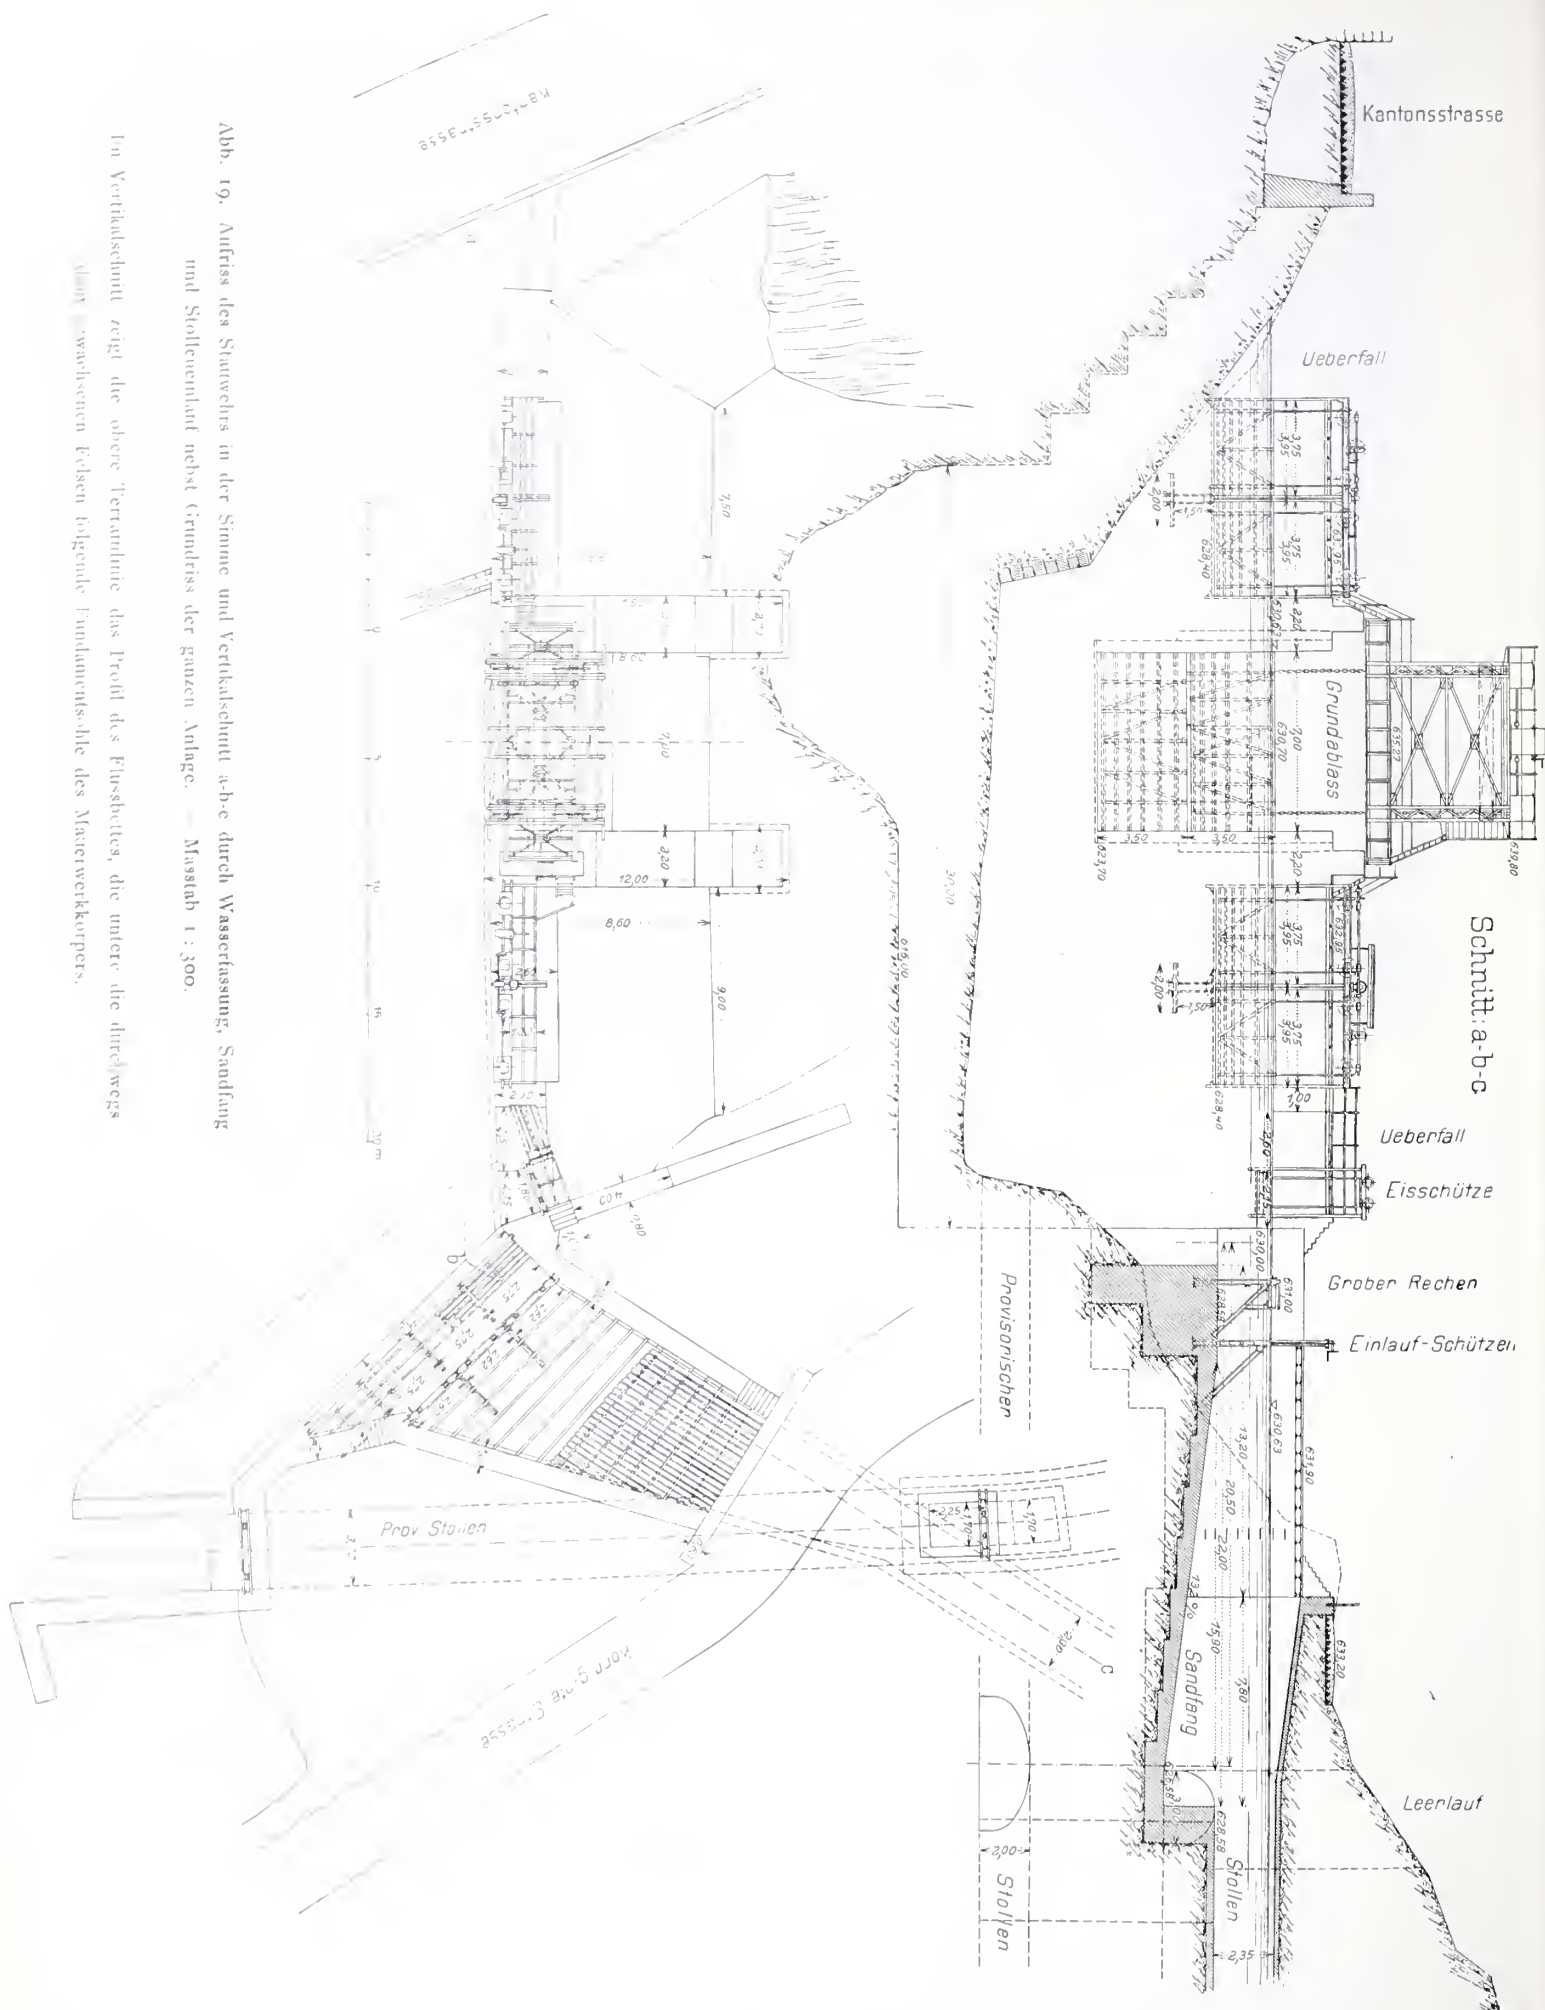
Aufriss des Stautechs in der Stinne und Vertikalschnitt a-b-c durch Wassereinfassung, Sandfang und Stollenlauf nebst Grundriss der ganzen Anlage. Massstab 1:300.
